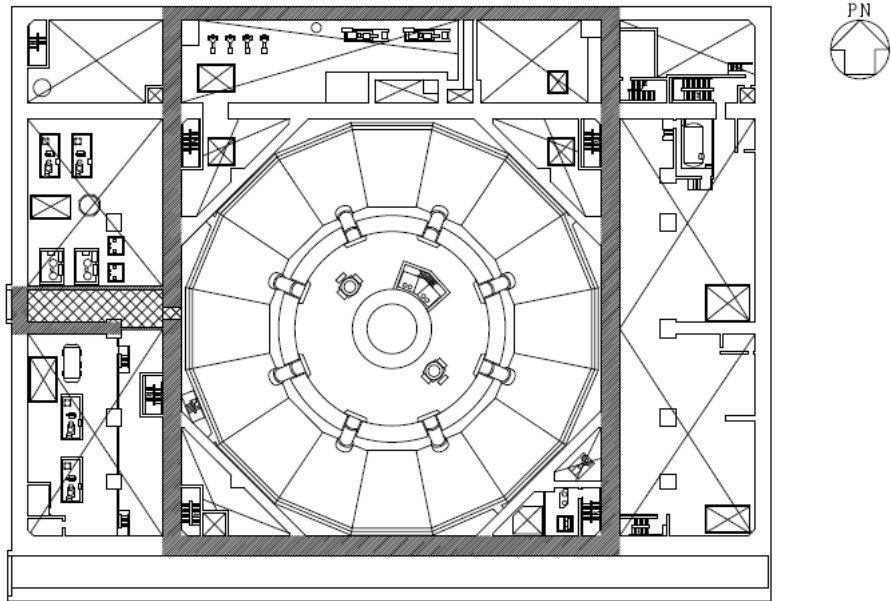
(1) 原子炉建物原子炉棟 (二次格納施設) の範囲の平面図
